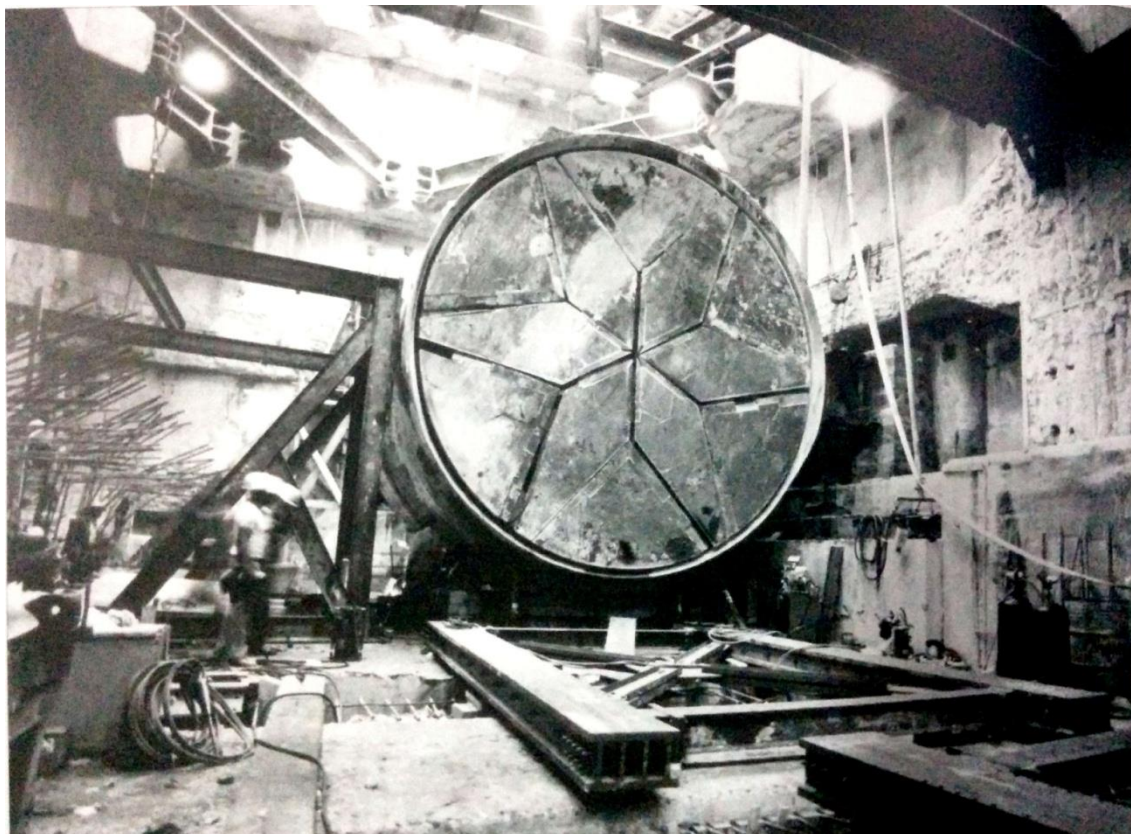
Tuneladora utilizada na Linha 1 do metrô de São Paulo
